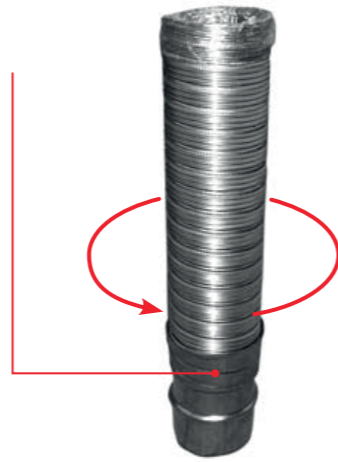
Instructions de montage du manchon étanche avec joint silicone.
